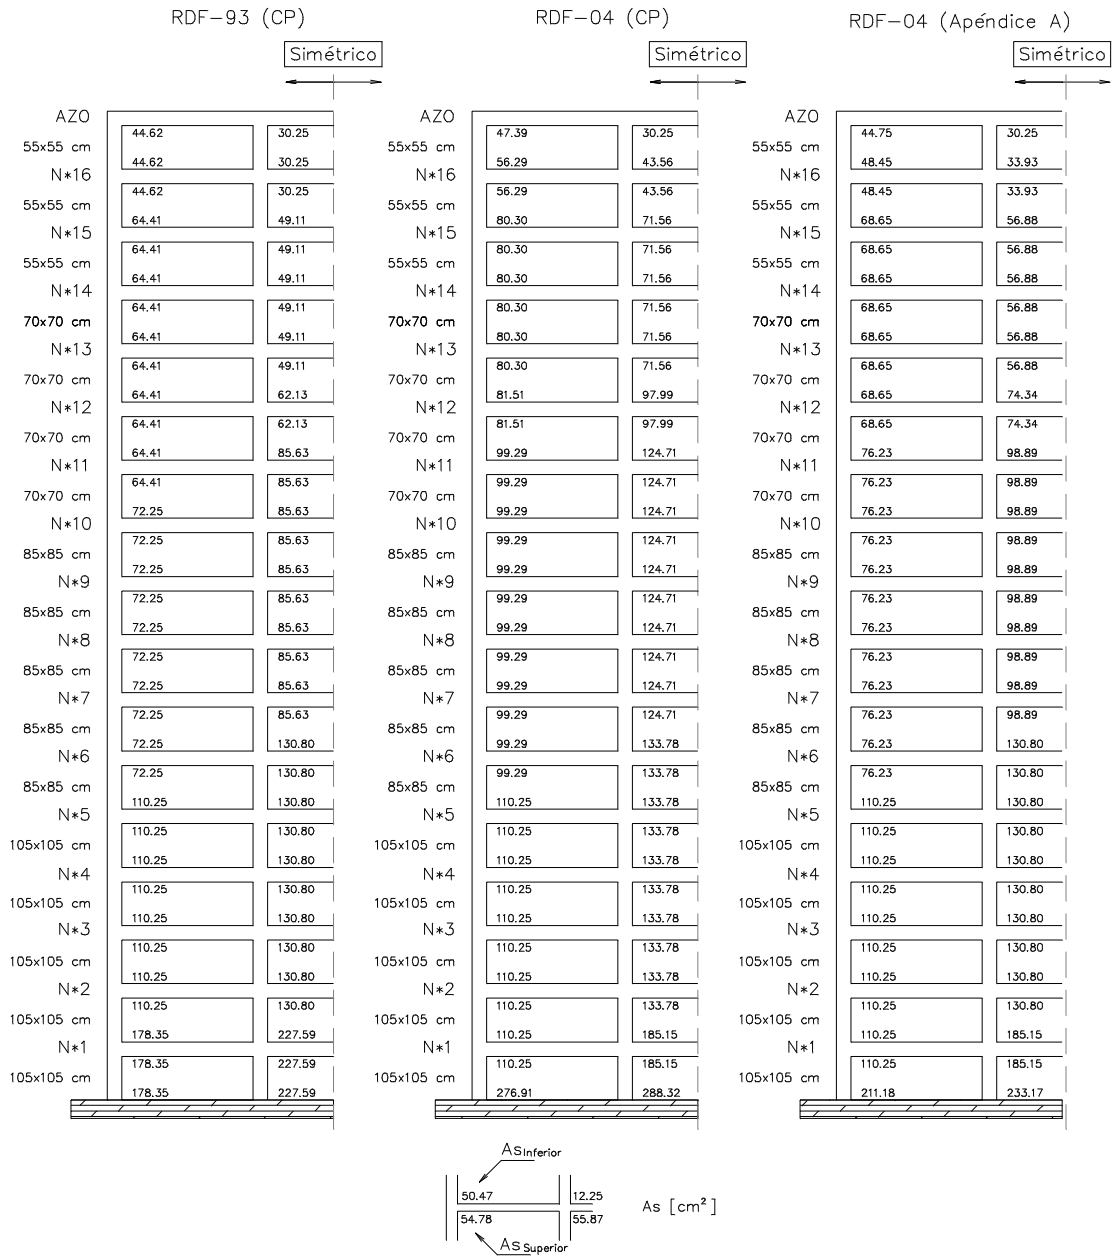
Comparación de áreas de acero de refuerzo longitudinal de las columnas del eje 2 de las estructuras diseñadas en zona III (RDF-93 y RDF-04)
